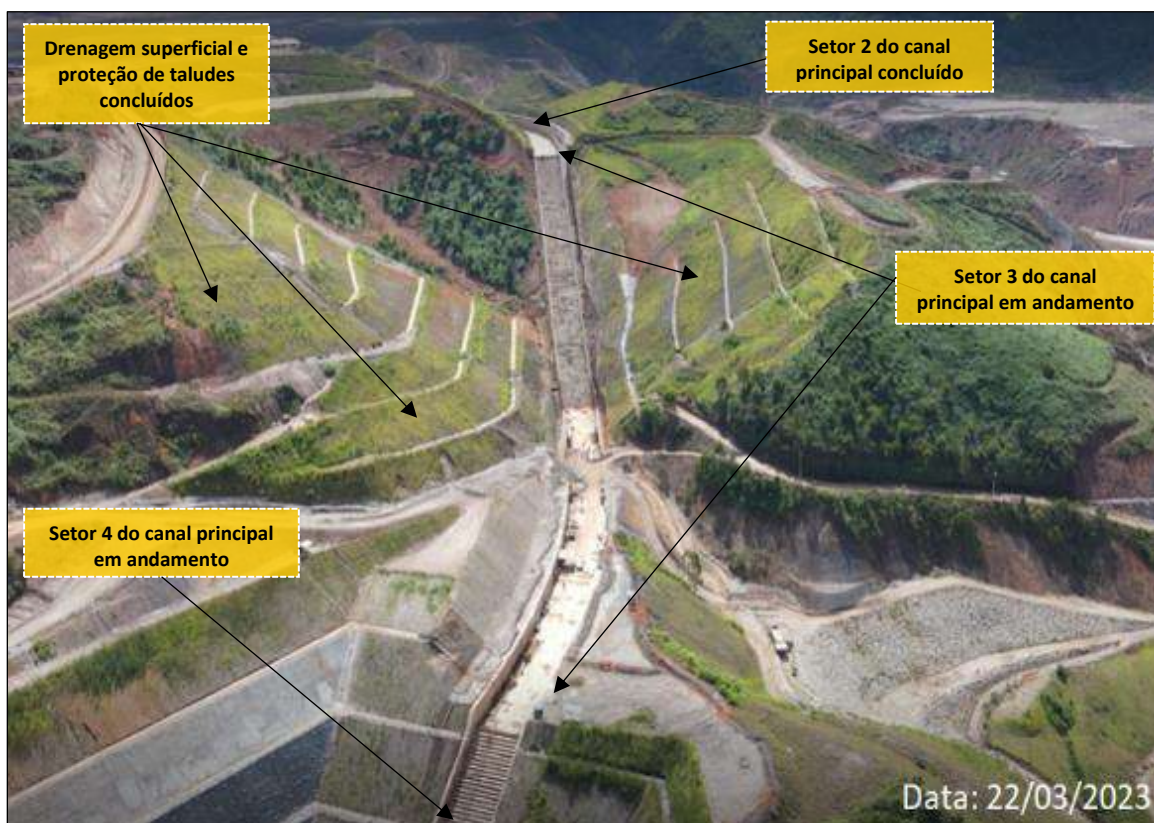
Vista do Setor 3 do Canal Principal – Paredes do Canal Em Andamento
